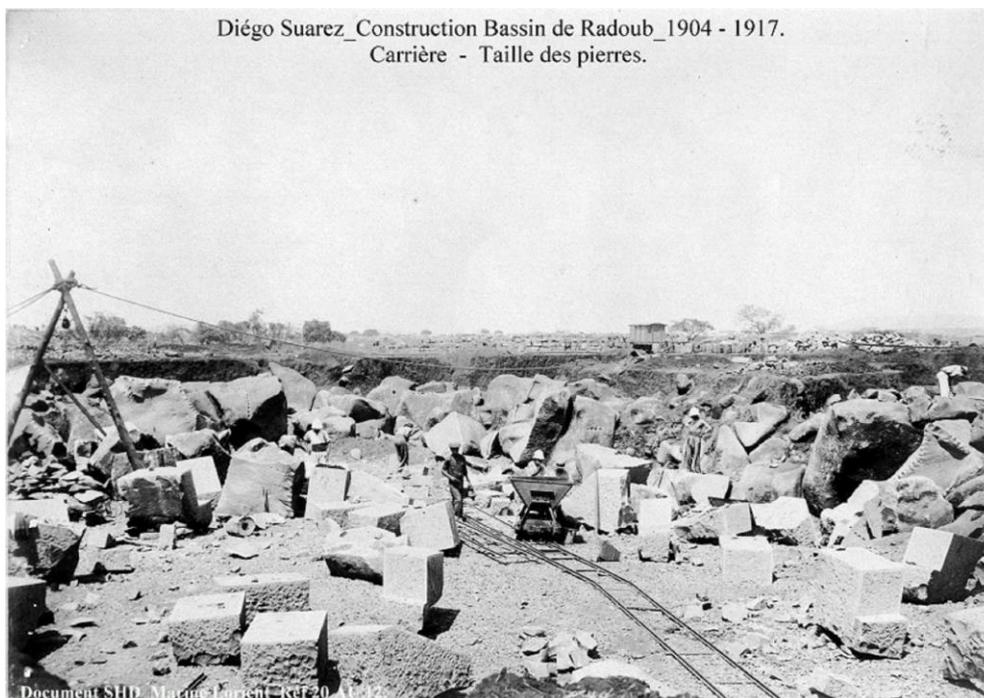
Carrière – Taille des pierres de parement (Archives SHD Lorient)
